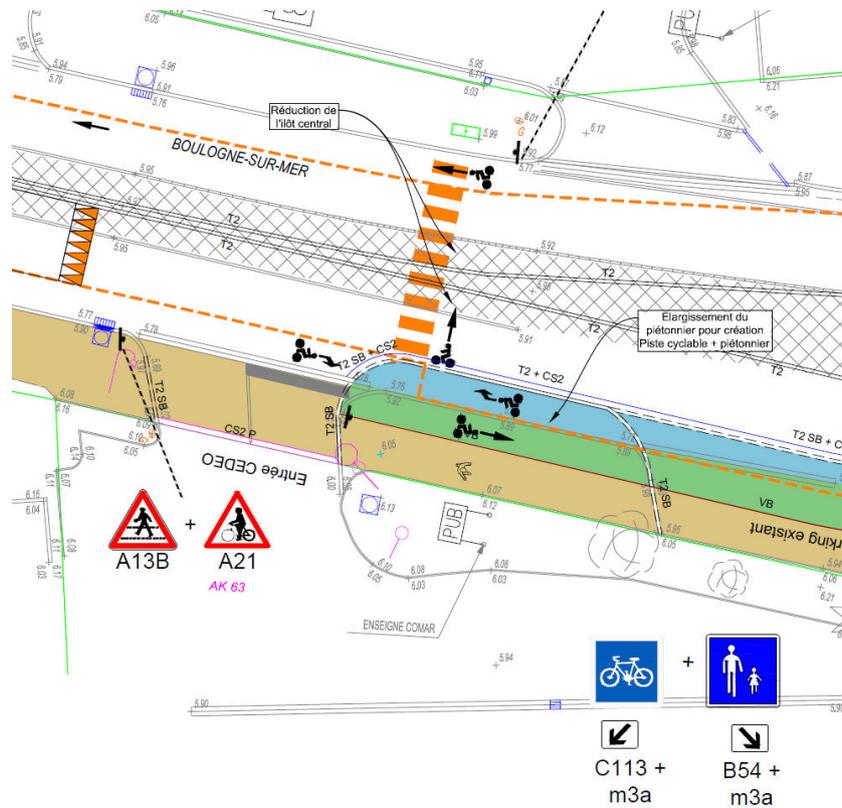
Vue en plan - Traversée au niveau de la séparation du boulevard
